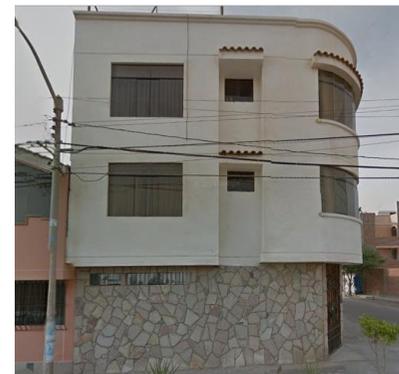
Vivienda 03 niveles de concreto- ladrillo
